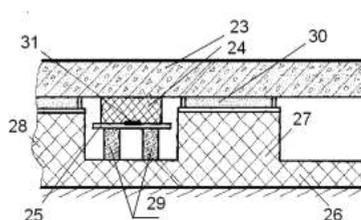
Схема виброизоляции железобетонной плиты в основании здания.
